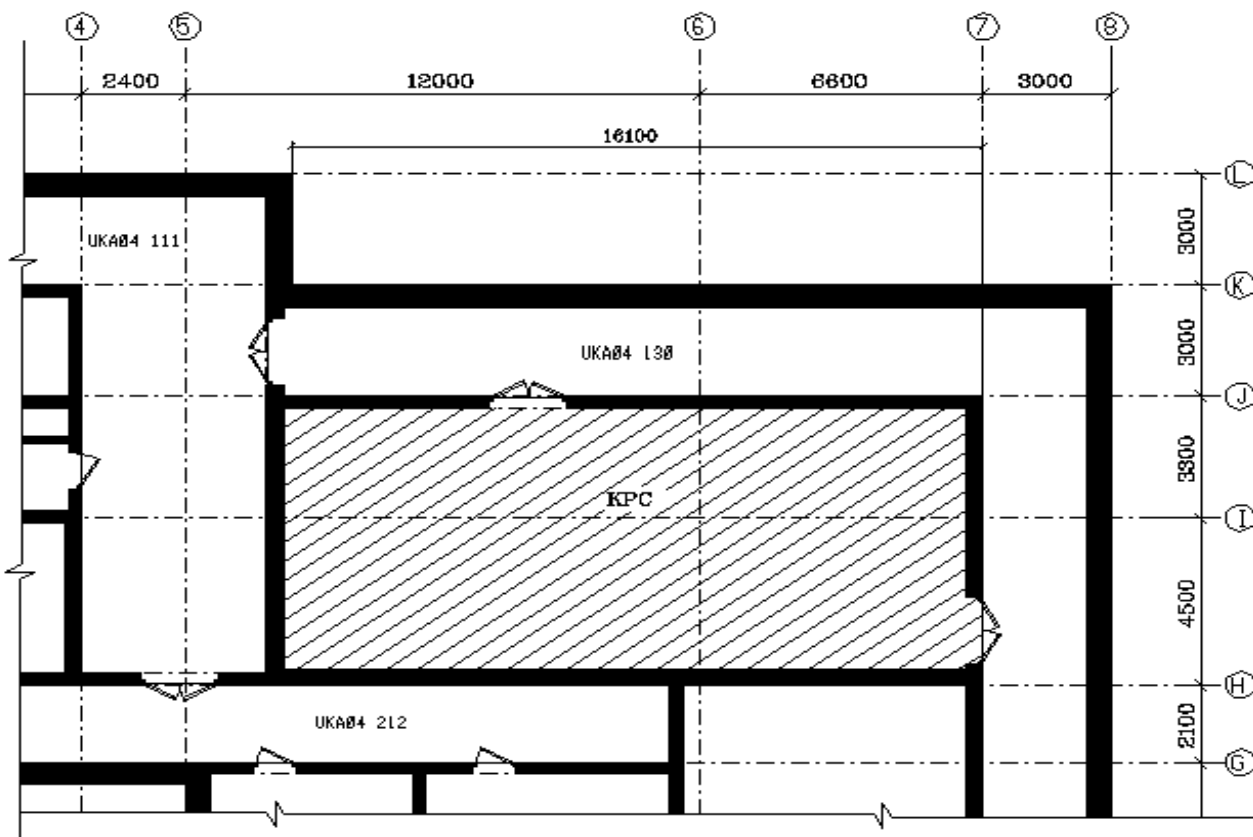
Фрагмент плана вспомогательного корпуса (УКА) для расположения оборудования установки отверждения на отм.+4,800
